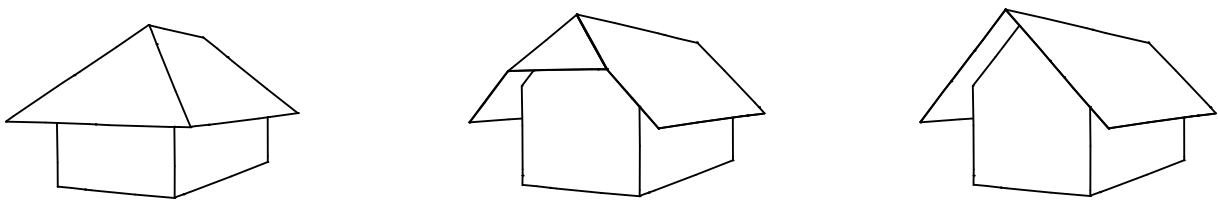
| Walmdach - Halbwalmdach - Satteldach
